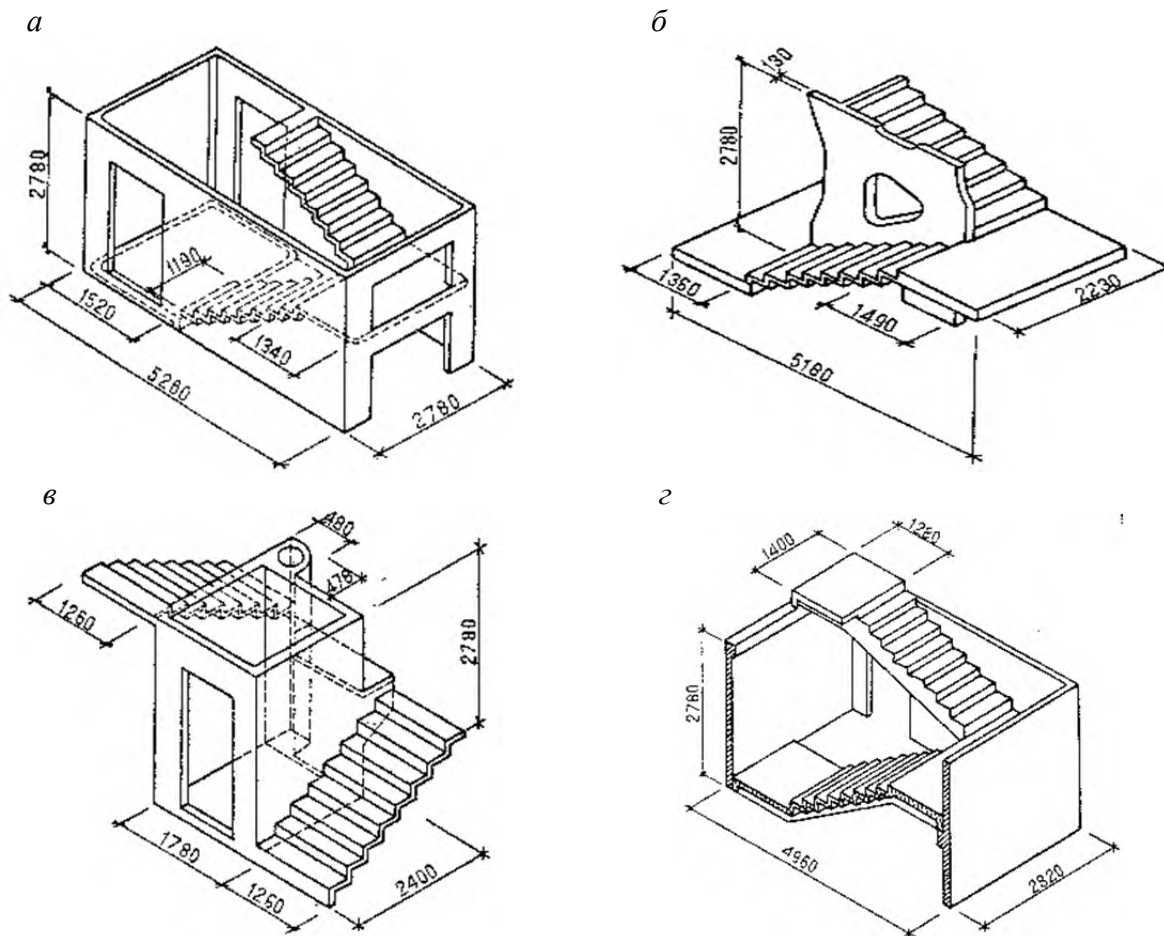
Железобетонные объемные лестничные блоки:
